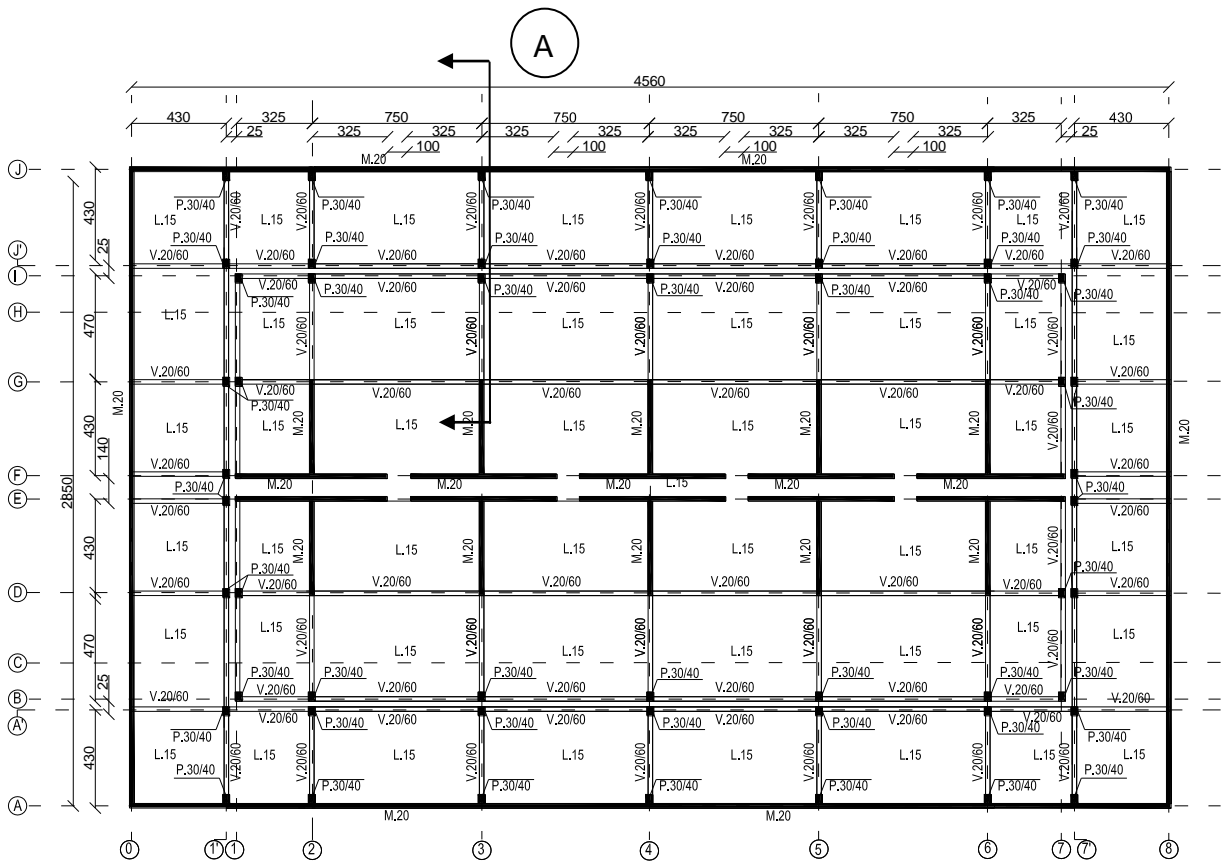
Planta estructuras subterráneo, edificio aislado.
